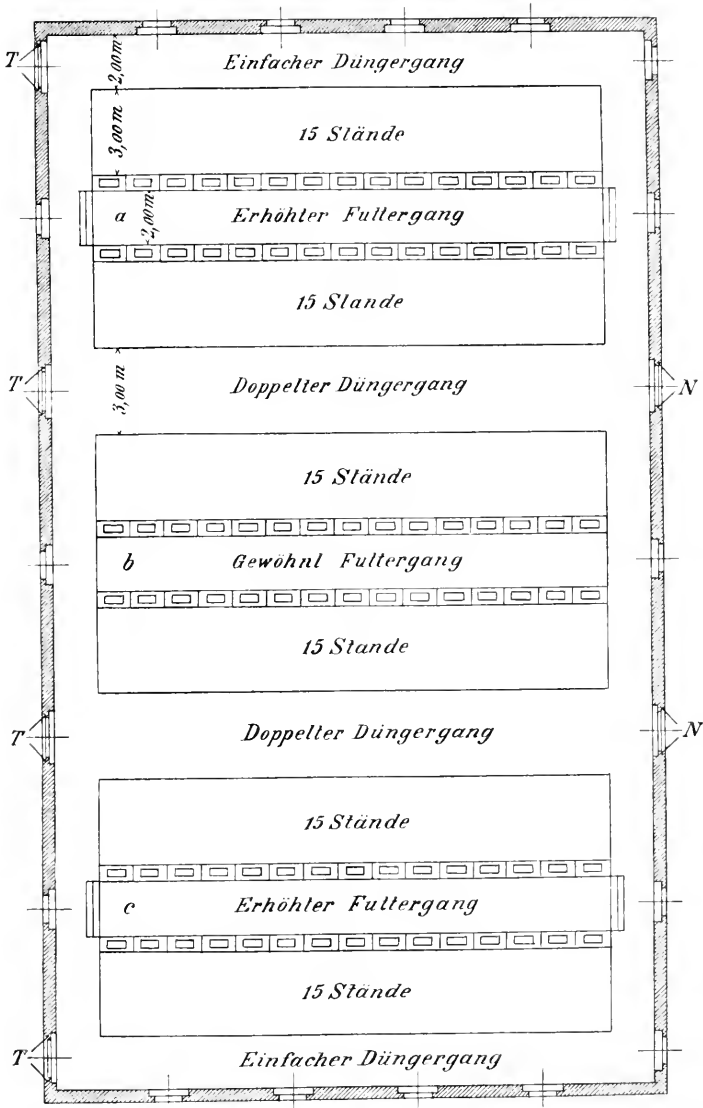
Grundriss eines Rinderstalles für 90 Stück Grossvieh in 6 Querreihen.
